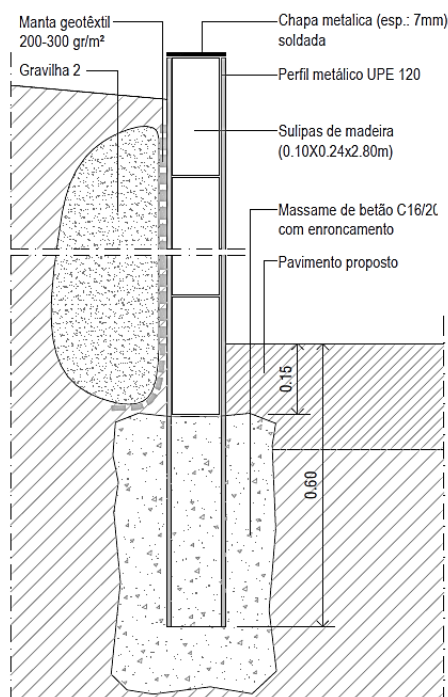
Detalhes do Suporte em Estrutura em Madeira [13]
